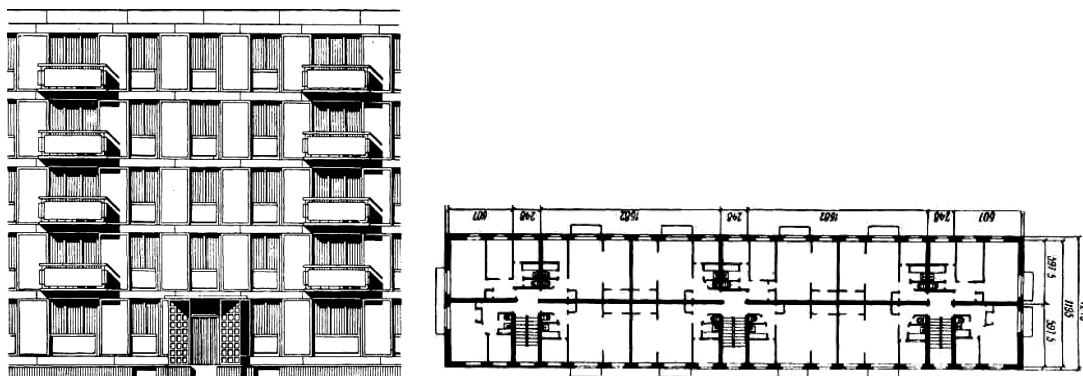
Проект експериментального великоблочного будинку з однорядним розрізанням стін. Фрагмент фасаду і план поверху
